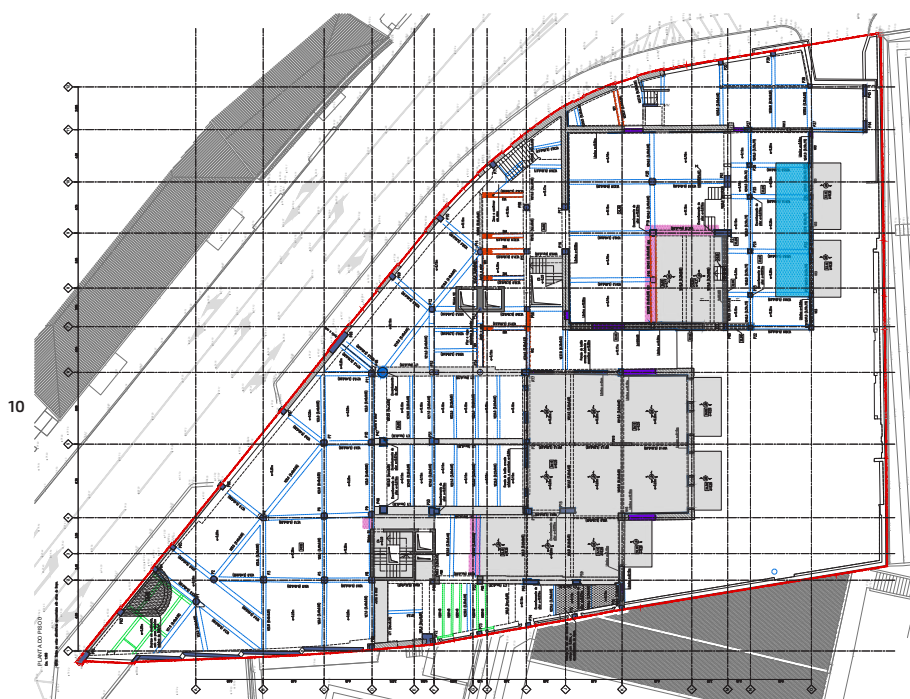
Planta de um piso (1º). Plan of one floor (1 st).
